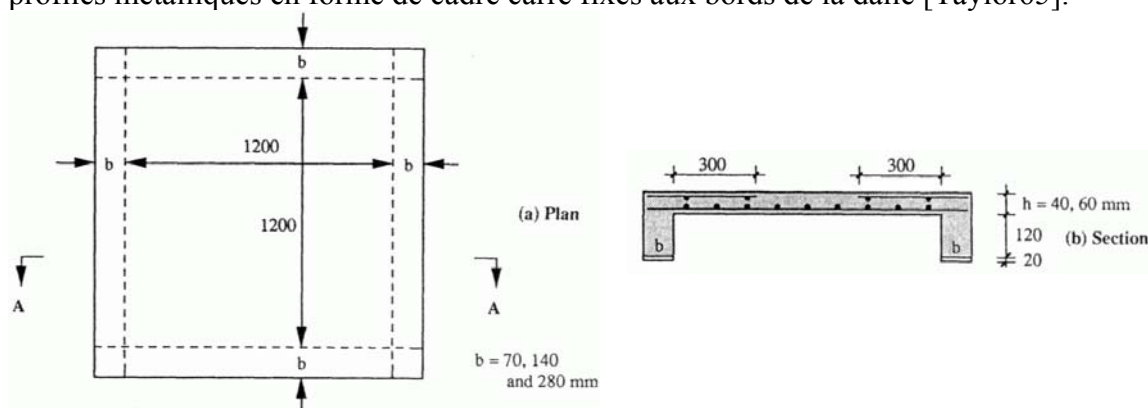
Dalles d'essai encastrées avec des poutres de bord [Kuang92]
